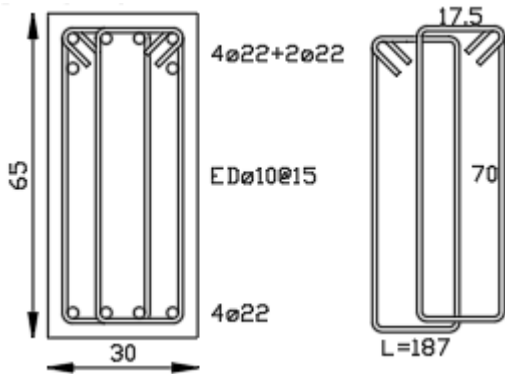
Vigas ejes 1 y 4, nivel 1-5. Edificio 15 pisos
